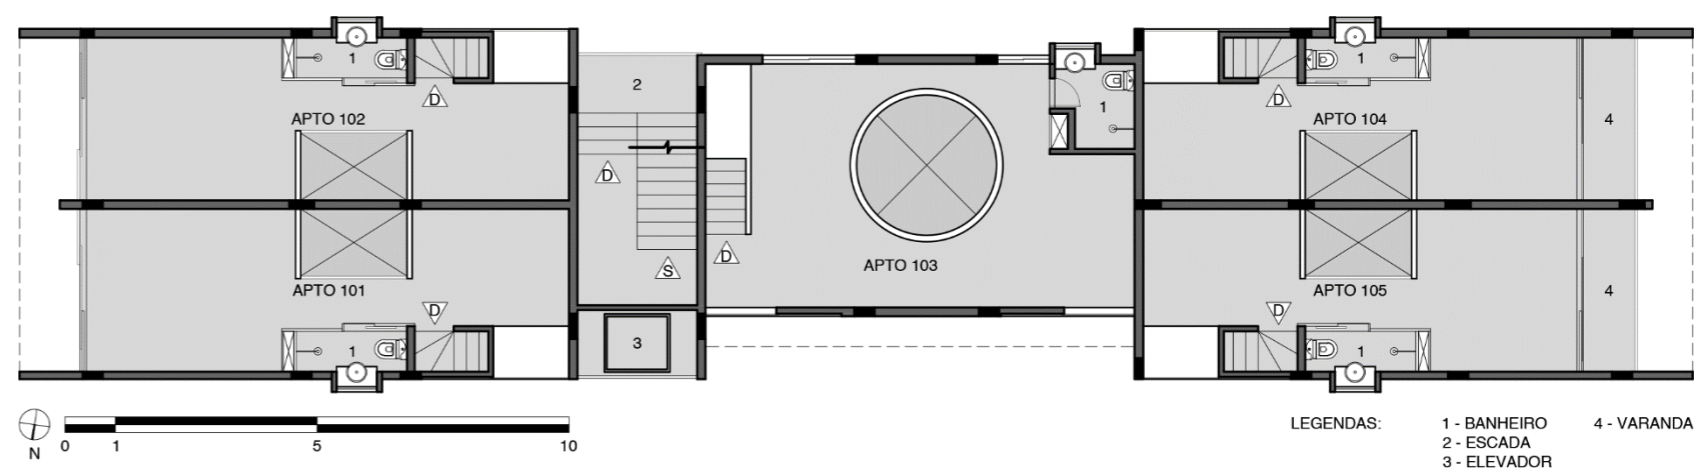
Planta do segundo pavimento dos Estúdios Capelinha
